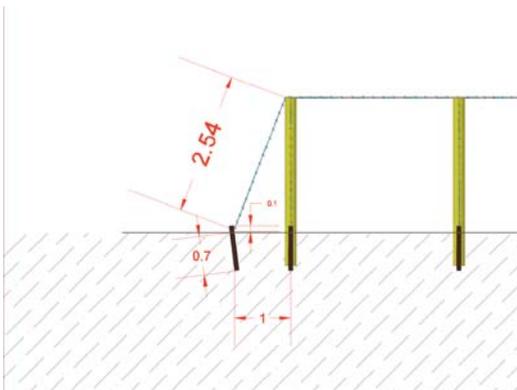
Vista en detalle del anclaje de la estructura de soporte. Diseño CREDyCOM
